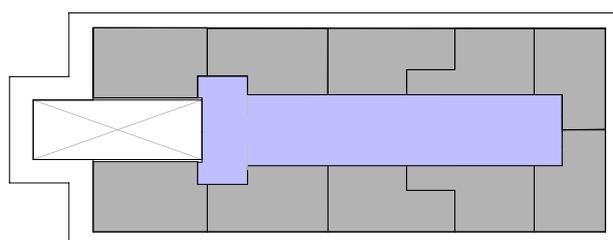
Planteamiento 2 de la distribución planta primera.
